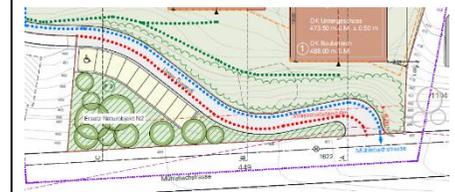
Ausschnitt Situationsplan Gestaltungsplan Boden
